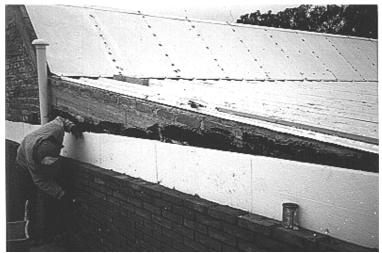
Detalle de Colocación de Aislación Térmica y Muro de Revestimiento
